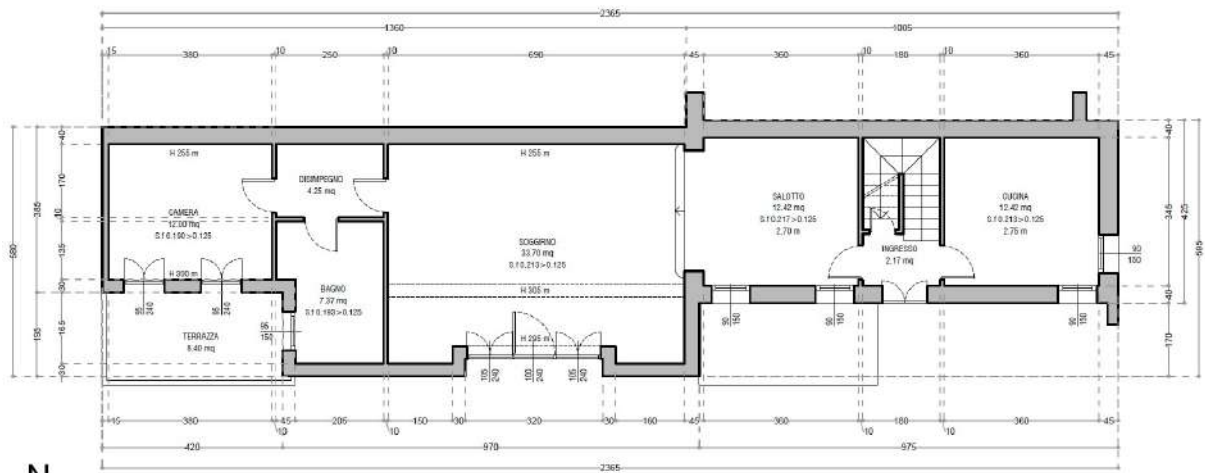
Planimetria P.lla 953 sub. 1 e P.lla 189 abitazione P.T. – stato rilevato
